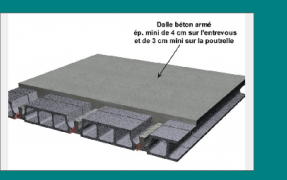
ENTREES PLANCHER POUTRELLES-HOURDIS
